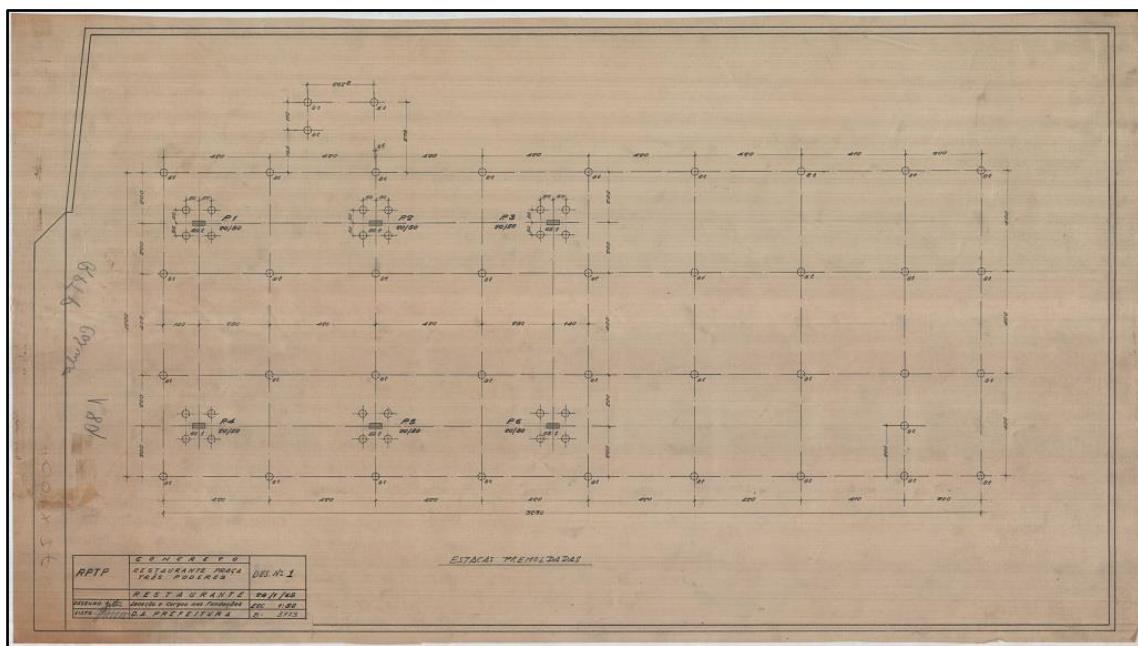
Jan. 1965 – RPTP-Restaurante. Des nº 1. Escala 1:50. Fundação – Locação e Cargas – D.A. Prefeitura. Arquivo: e129-m5 (7) Fonte: ArPDF
